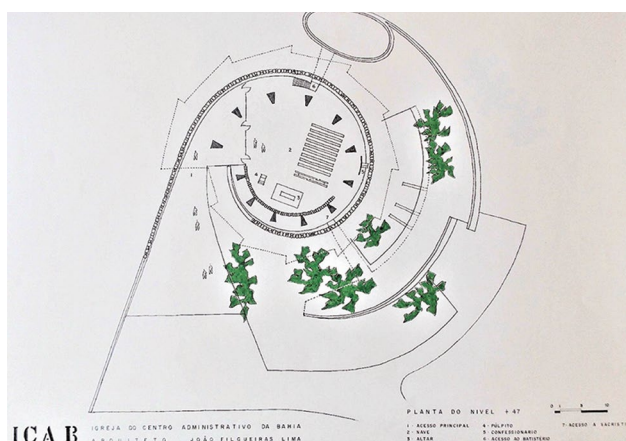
Planta baixa, nível térreo. 1973.⁶⁴
